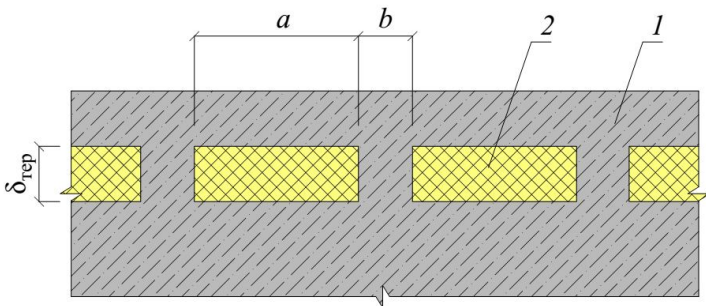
Схема перфорации плиты перекрытия (вид сверху): 1 – плита перекрытия; 2 – тепловая изоляция (термический вкладыш)
